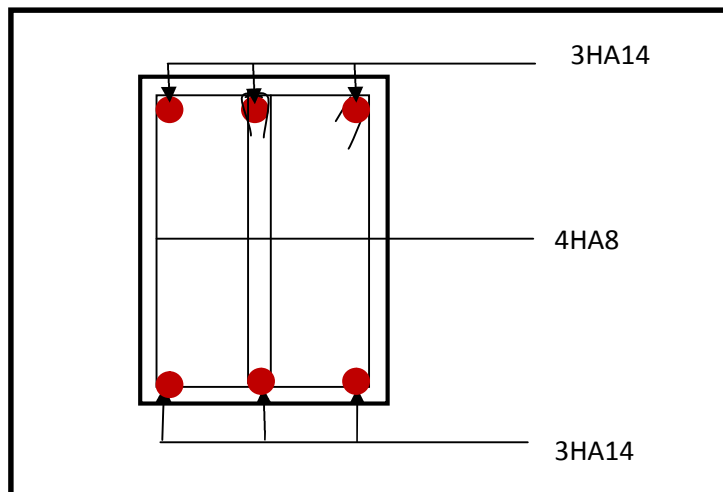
Figure.VI: Ferraillage en travée d'une poutre principaleSur appuis :
